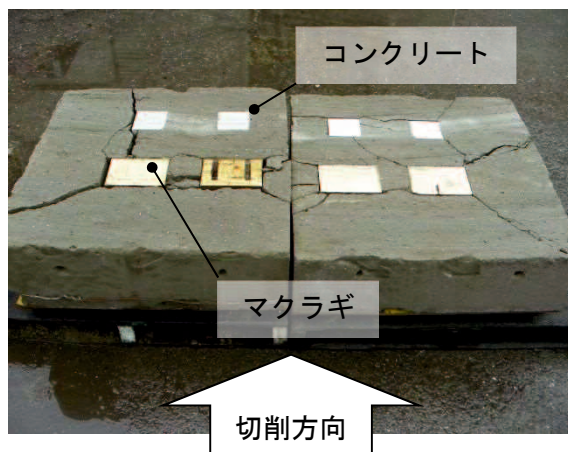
切削面の状況（マクラギ，コンクリート）
